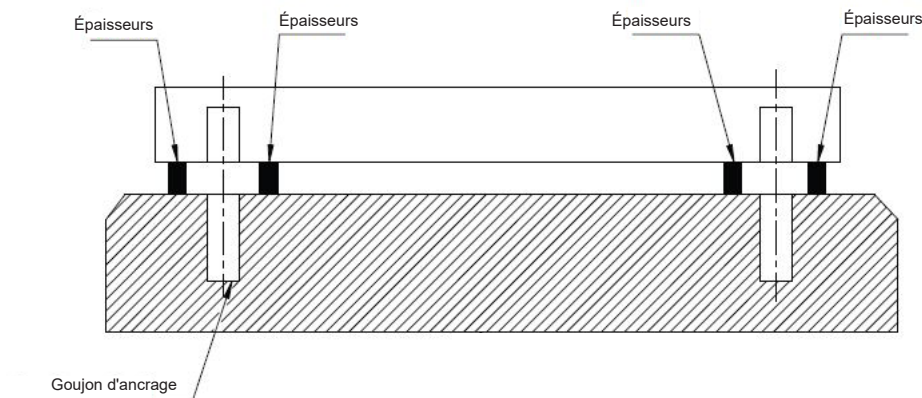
Application de fondations en béton, lame et ancrage
